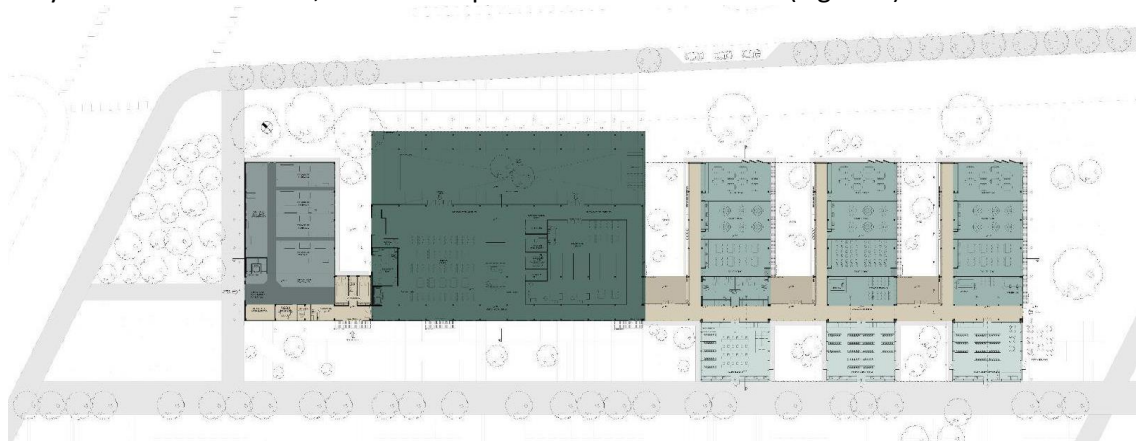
Planta baja del proyecto “Instituto Técnico Despeñaderos”.
